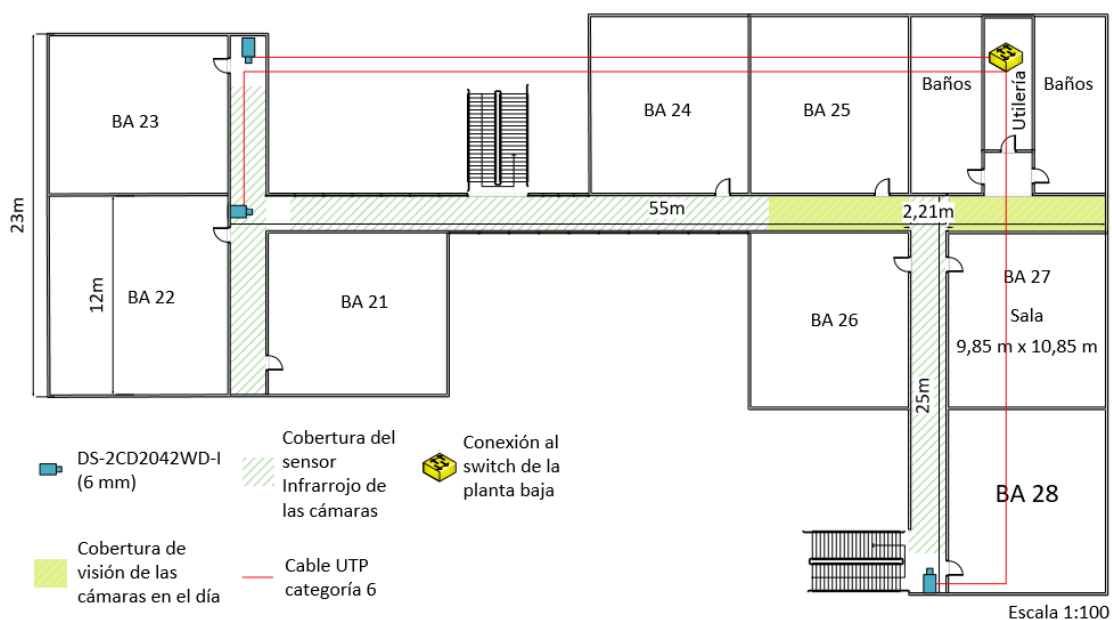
Ubicación de las cámaras el edificio 32 A, primer piso.
